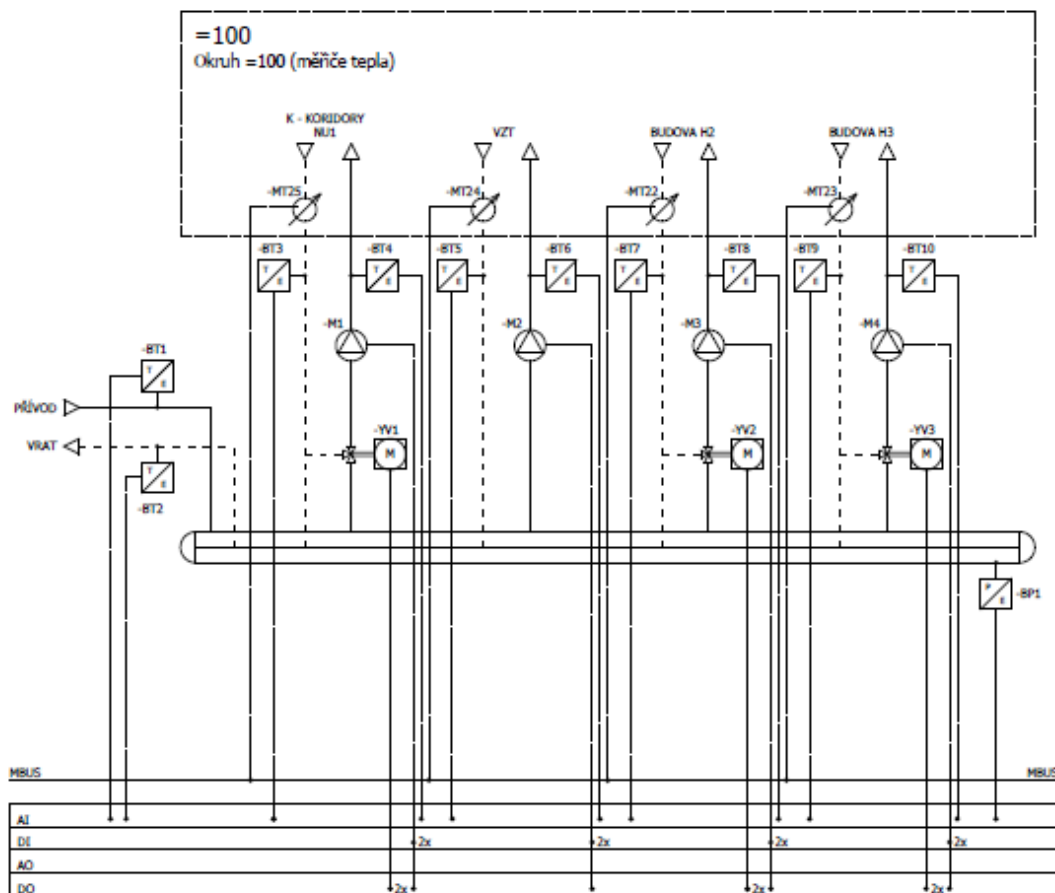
Příklad instalace měřiče tepla a jeho připojení
